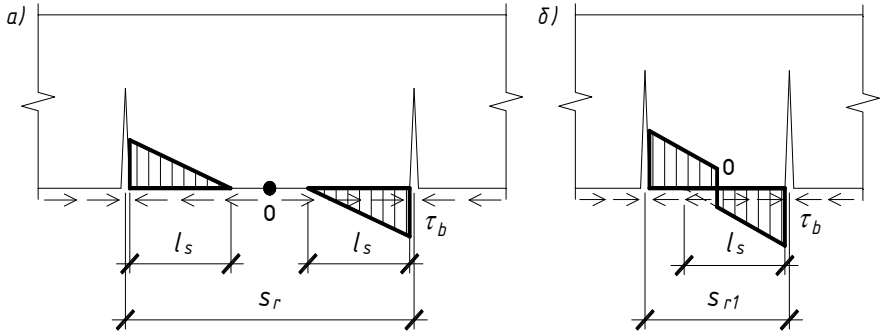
До розрахункових схем зчеплення арматури з бетоном в блоках: *a* – довгих; *б* – коротких
